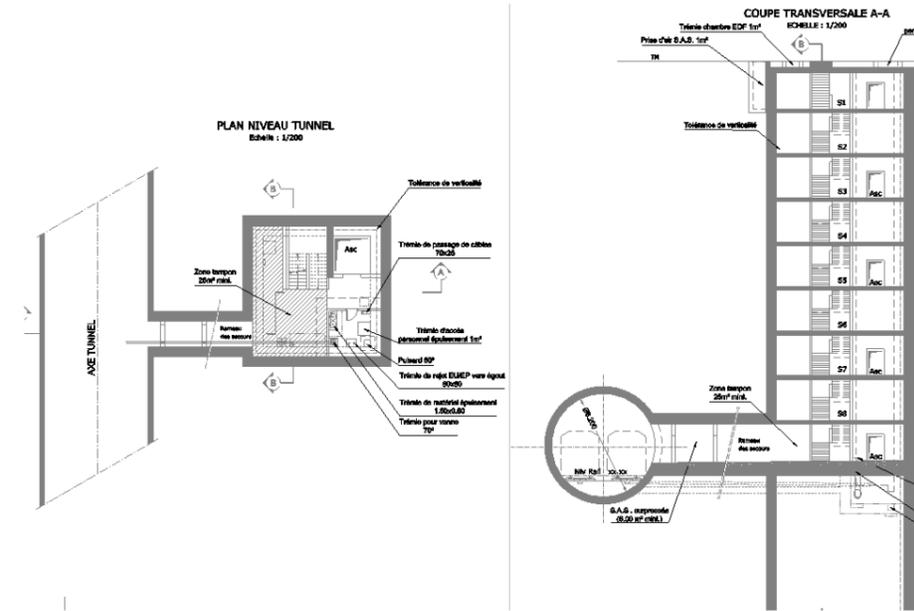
Coupe et vue en plan niveau cheminement OA accès secours et d'épuisement circulaire
